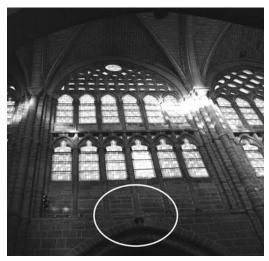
Ménsulas de apoyo para bóveda sexpartita prevista para la nave central y capiteles acodillados sobre los pilares para arranque de la bóveda
